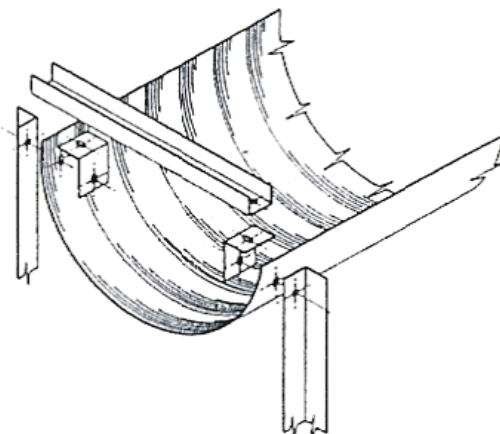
Vista assonometrica della canaletta in Armco - Finsider
